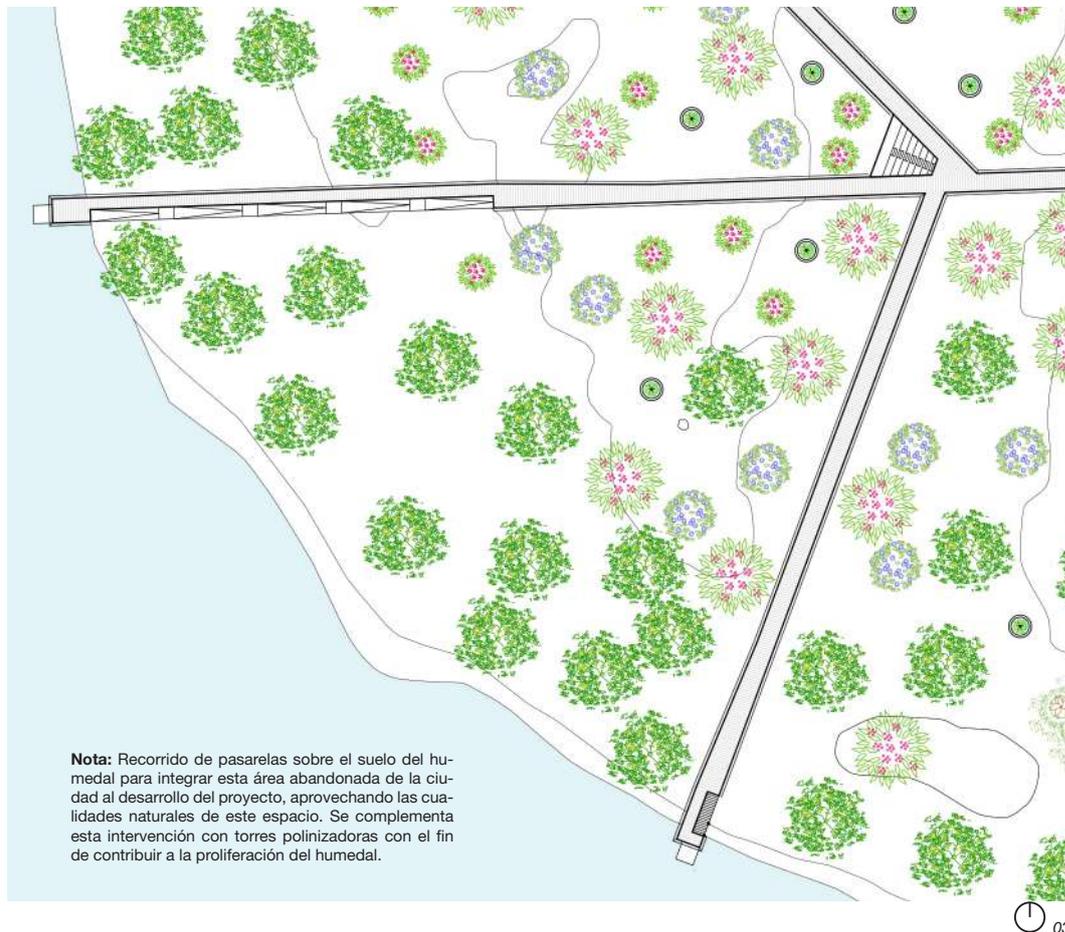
; Plano general de los muelles miradores desarrollados en la propuesta general.
